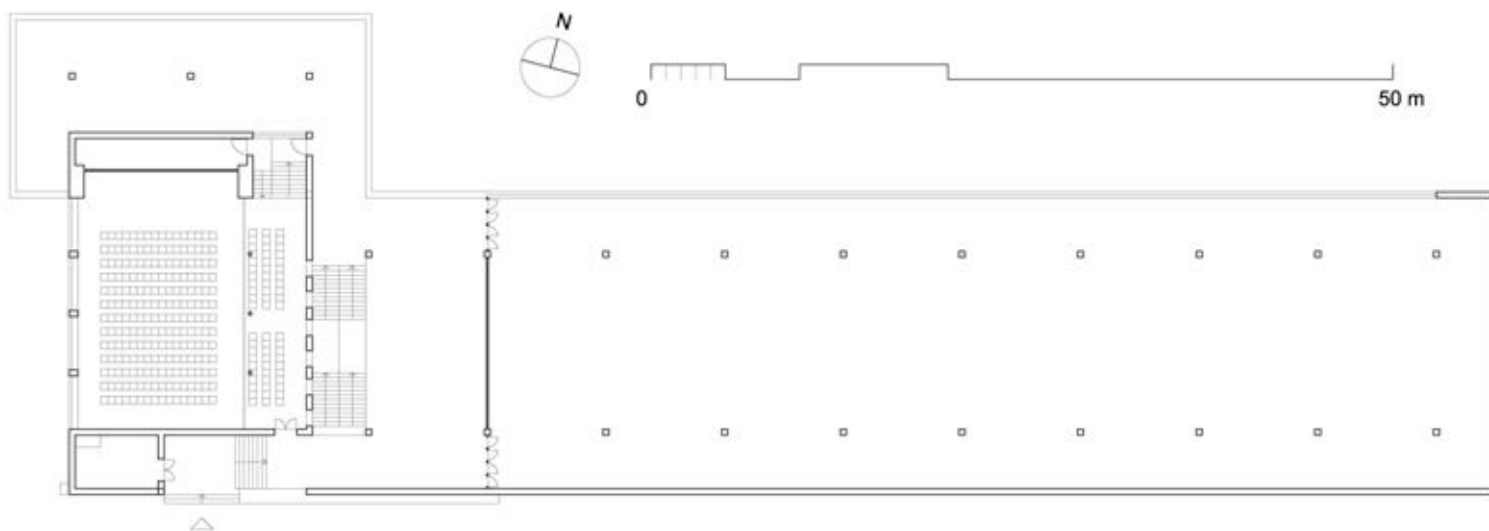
Planta primera del pabellón del INI, 1965. Dibujo del autor.
